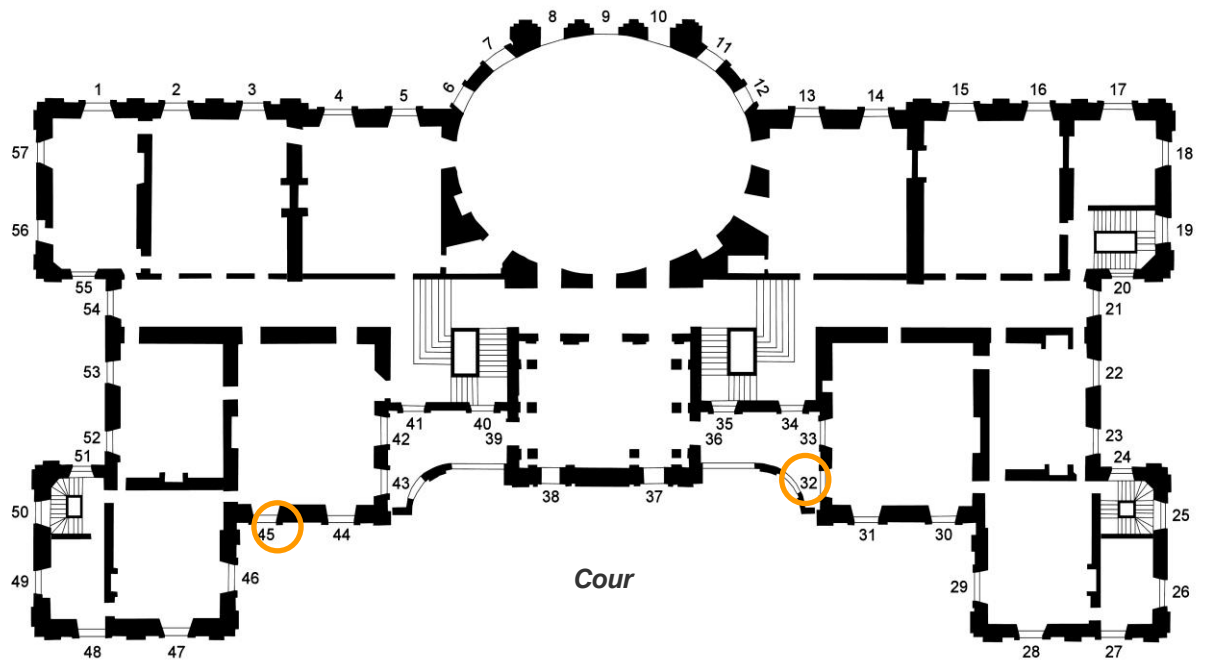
Plan d'implantation des prélèvements sur les croisées anciennes au niveau de l'étage (Source : relevé de Jean Baptiste Berthier, 1767)
